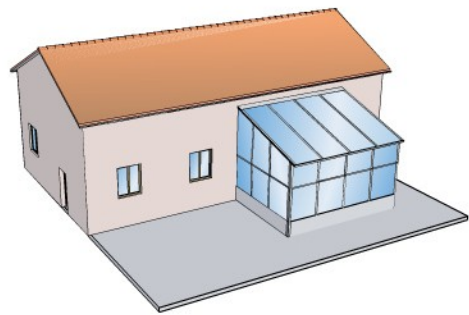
Exemple de « verrue » ou « boîte à chaussure »
